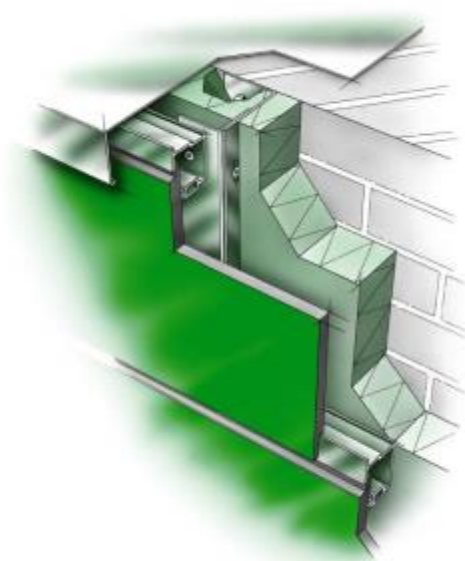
Coupe horizontale de la fixation de panneau par système modulaire (bords profilés)
